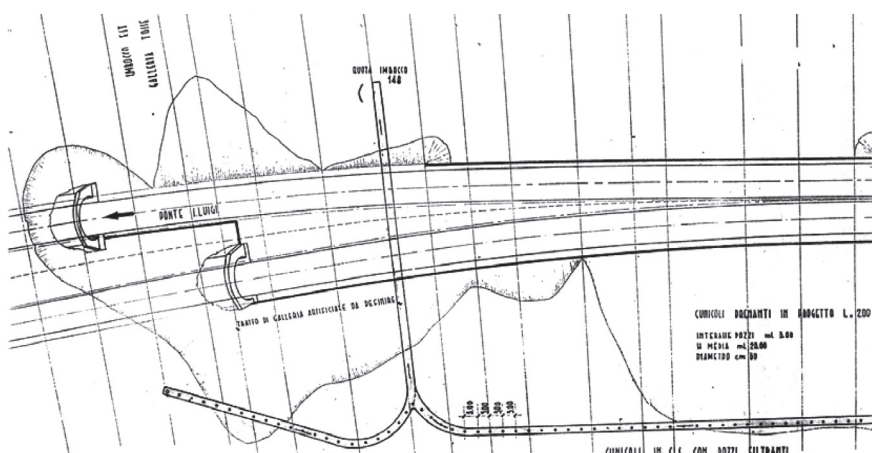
Schema planimetrico del sistema di drenaggio adottato nei pressi dell'autostrada "dei fiori" presso Spotorno (SV).
